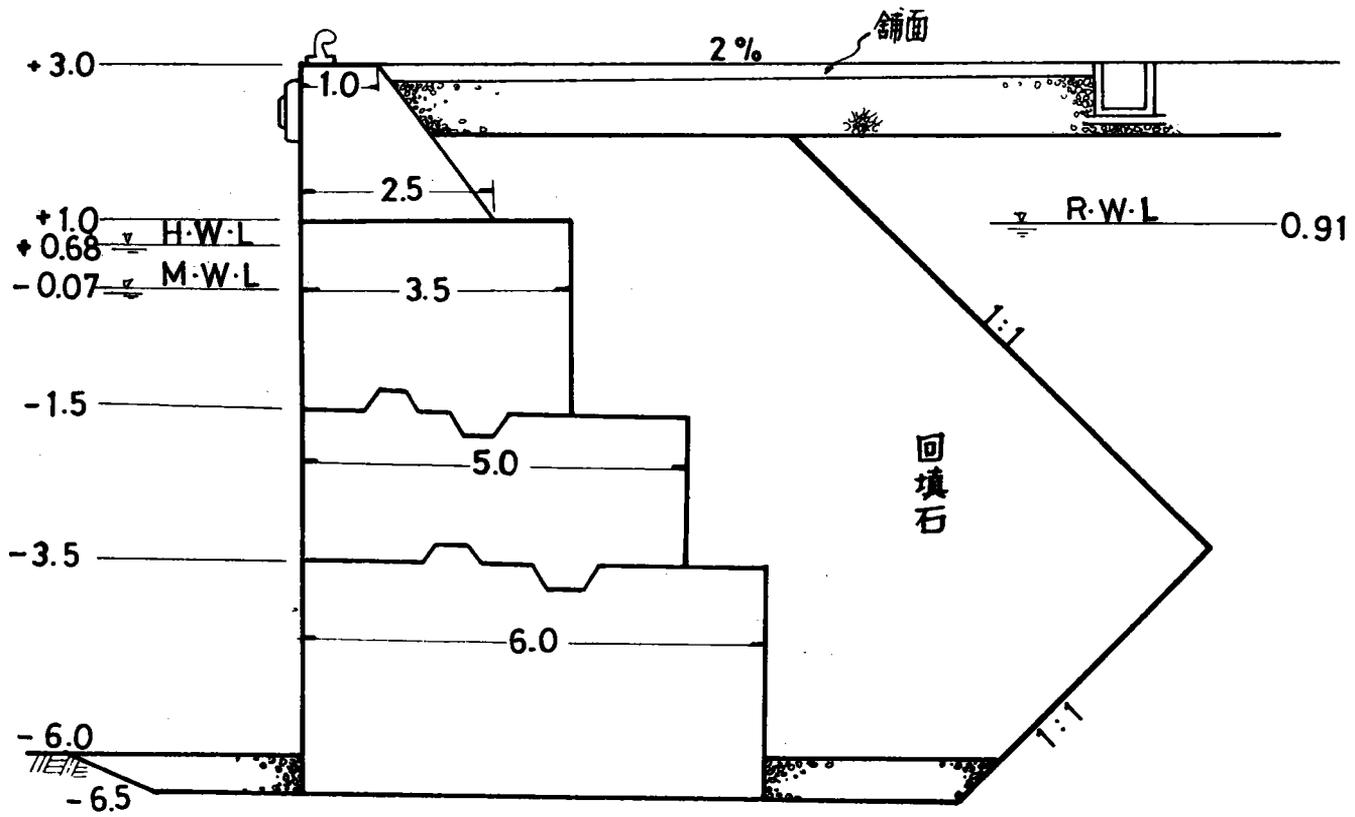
壟丁碼頭斷面圖 S : 1/100 單位 : m
